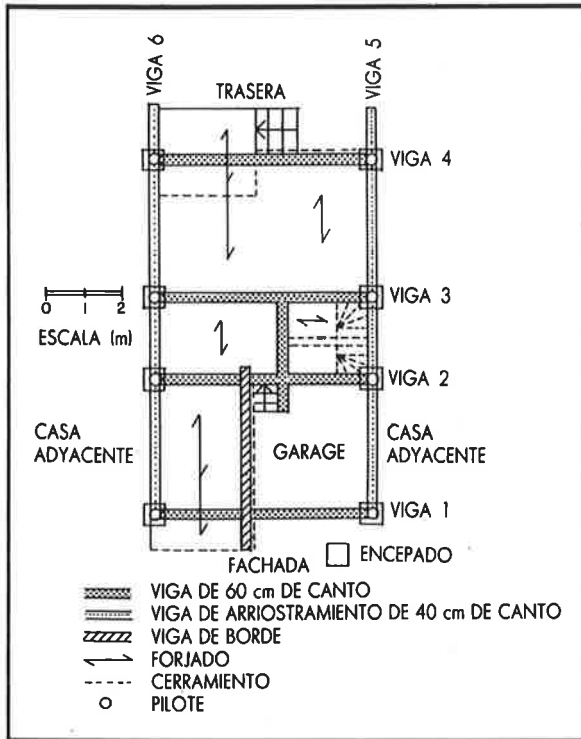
Cimentación y estructura de planta baja de una vivienda.
